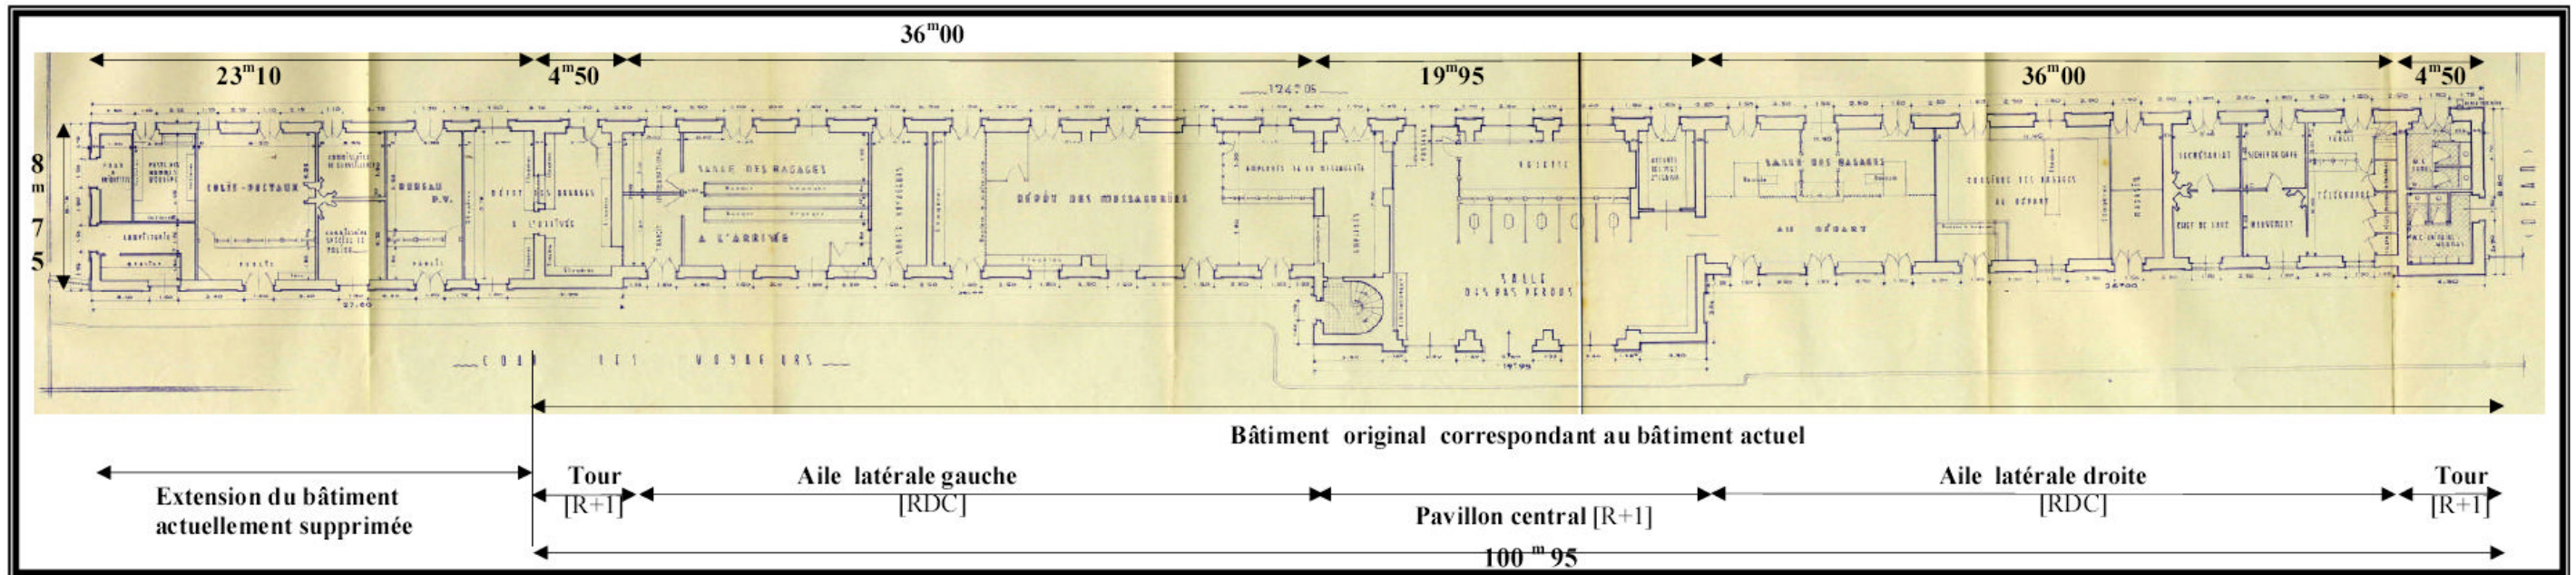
Plan du bâtiment voyageur de la gare d'Alger, comprenant le prolongement de l'aile latérale gauche.
